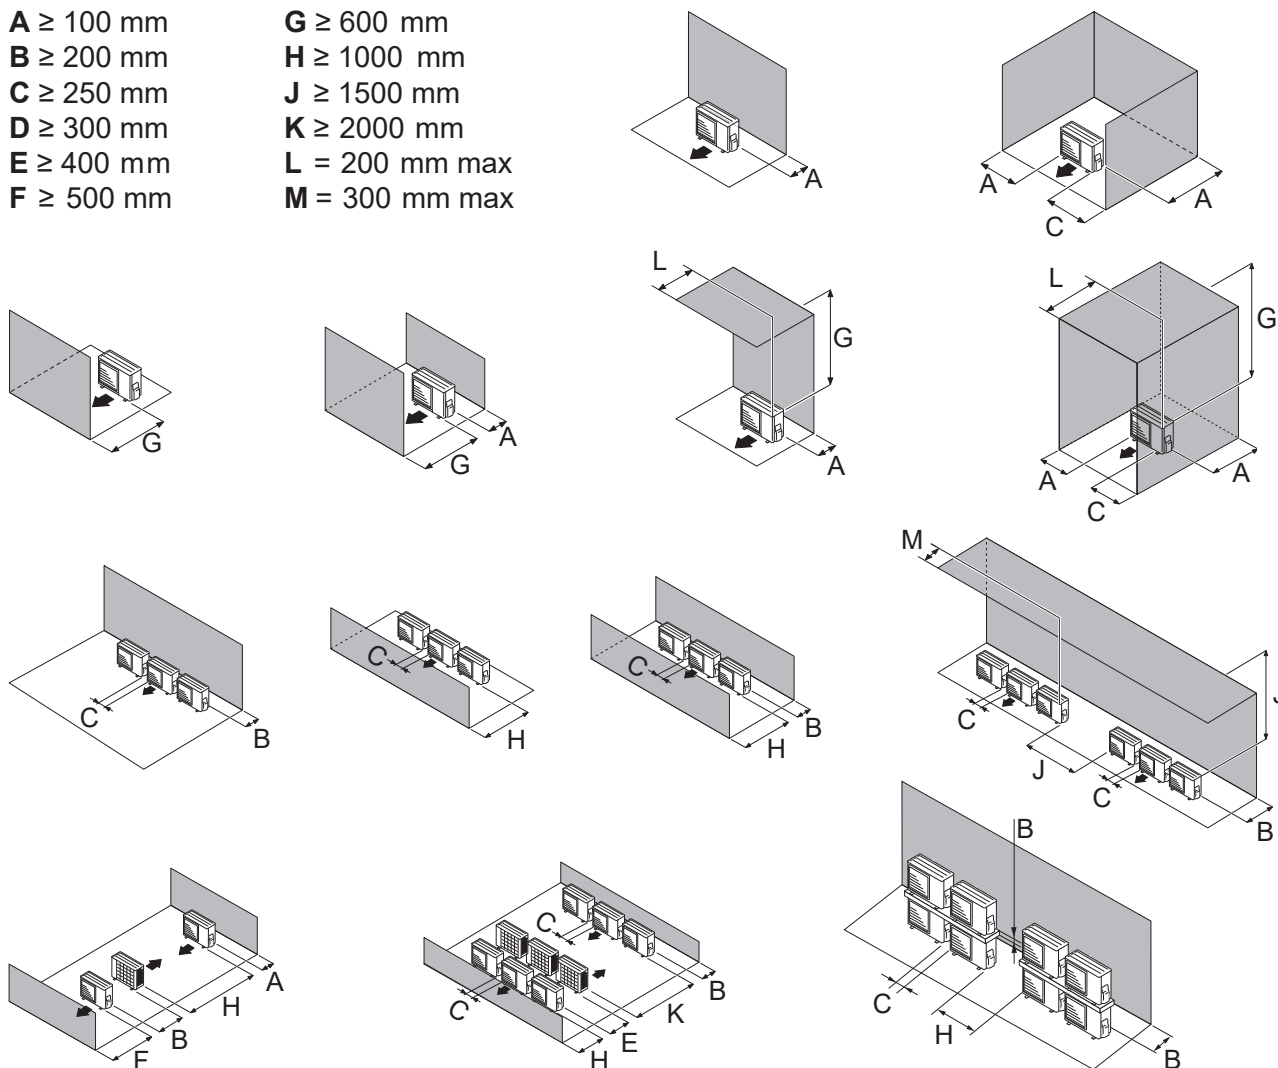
Minimale installatieruimte rond de buitenunit (model 5, 6 en 8)
